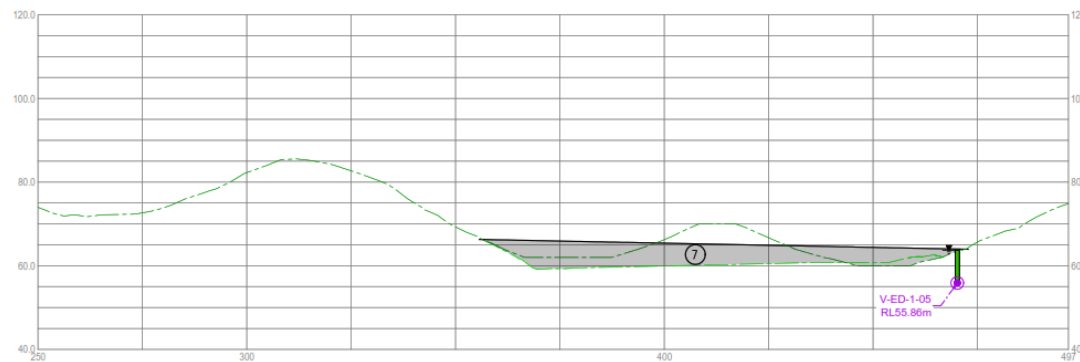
38: Vista de sección ED WRP1 "P-D"
